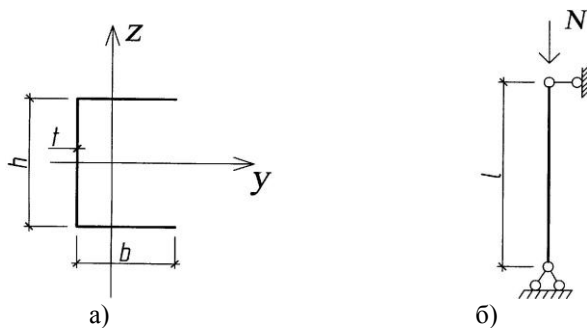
а – сечение рассчитываемого профиля; б – расчетная схема стержня.
